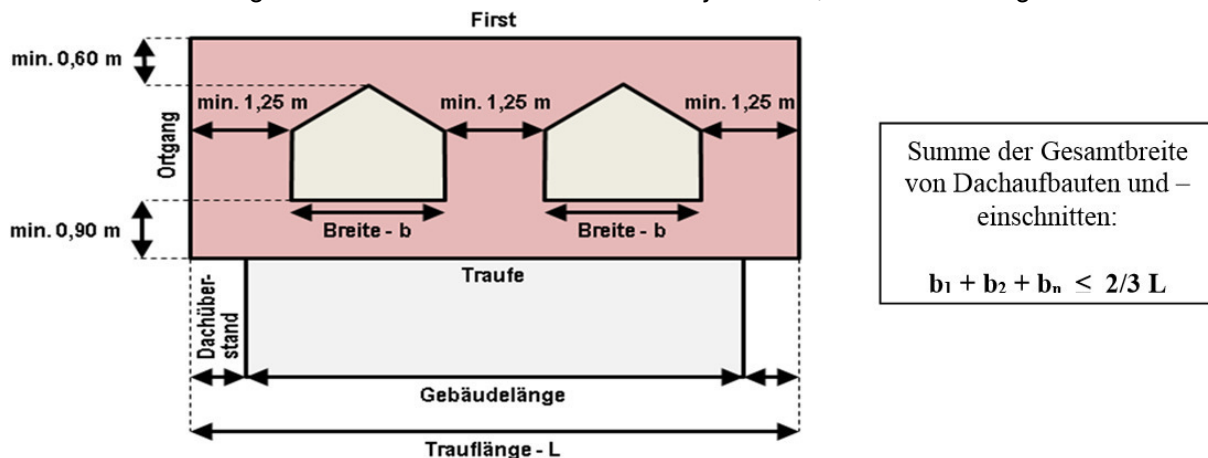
Abmessungen zulässiger Dachgauben (hier Beispiel: Sattelgaube)
